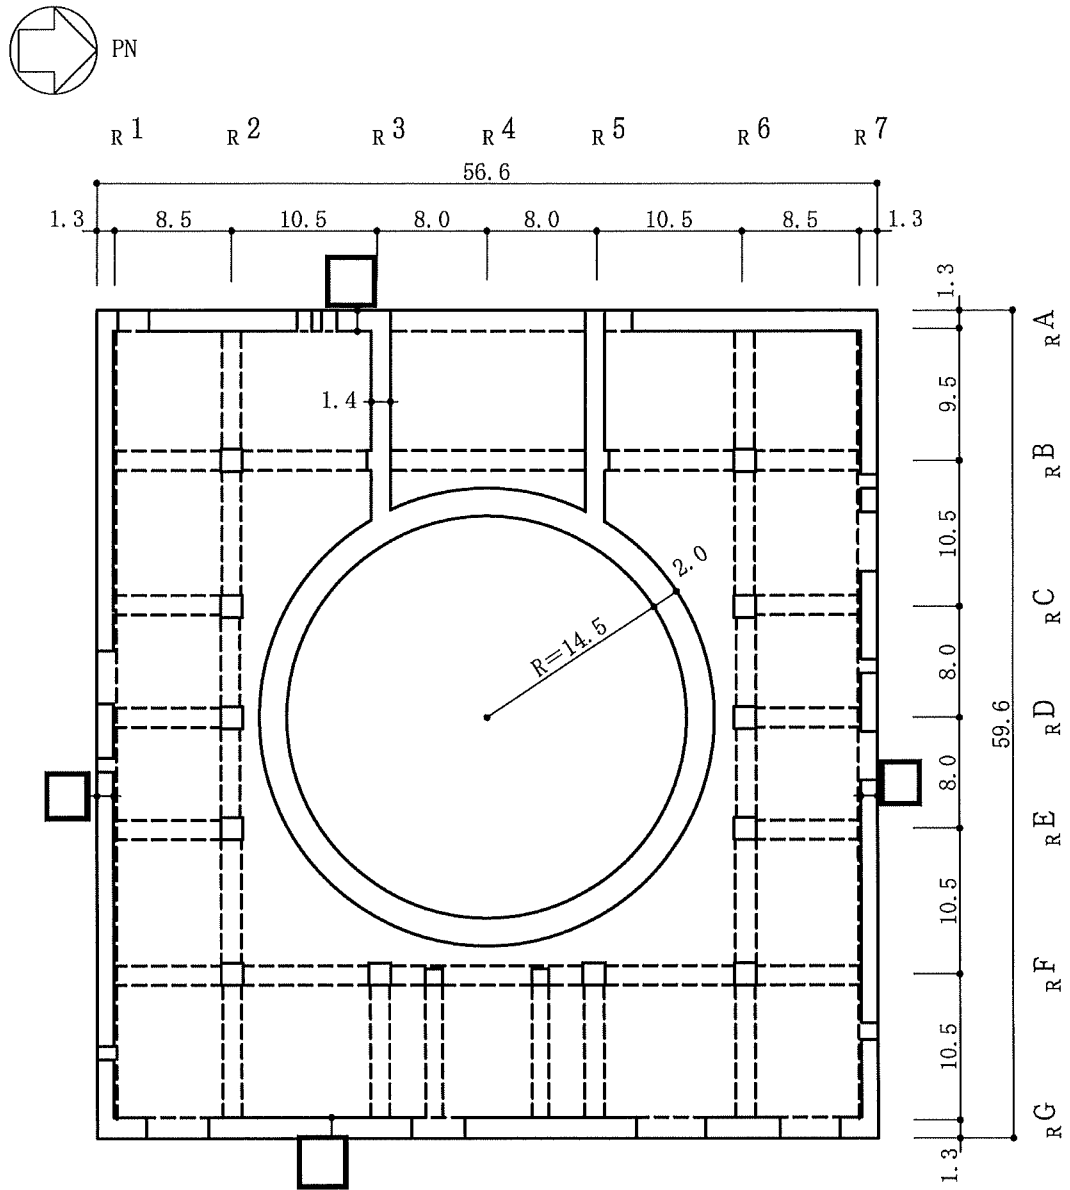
原子炉建屋の概略平面図 (1F, T.M.S.L. 12.3m) (4/9) (単位 : m)
